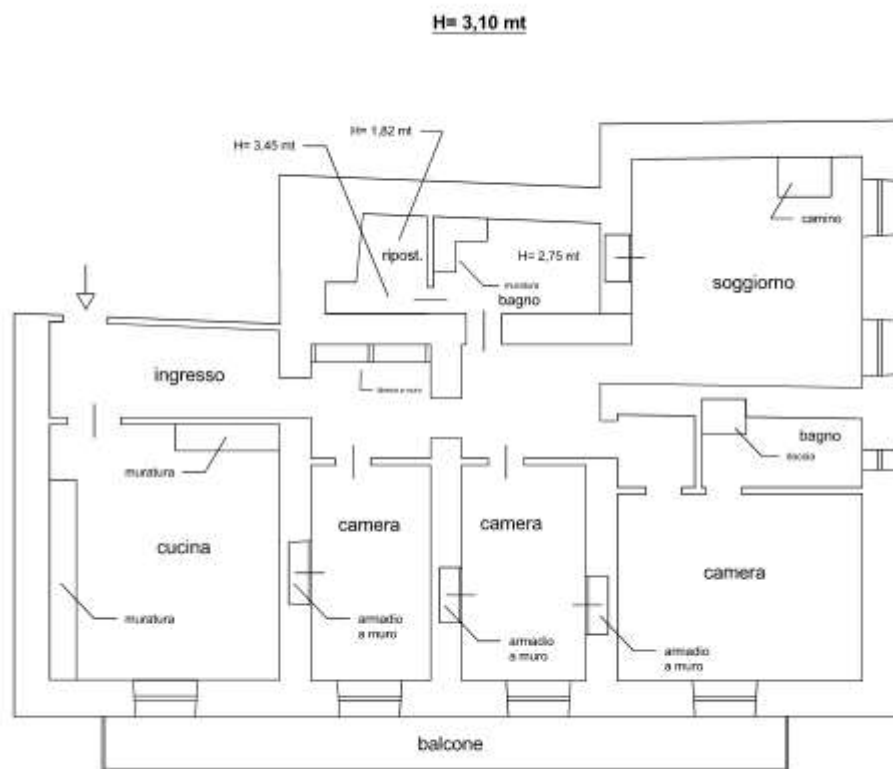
Planimetria Rilievo digitale – Stato attuale
